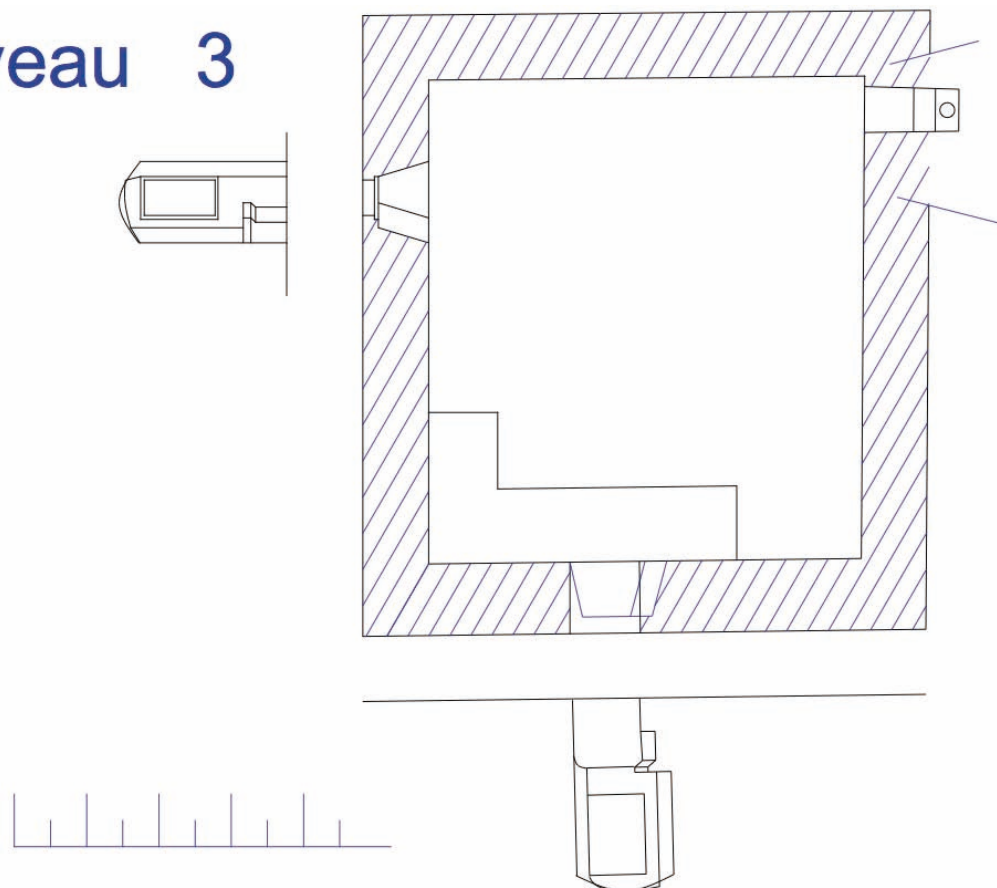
Plan du niveau 3 (DAO : P. Lhomme)
